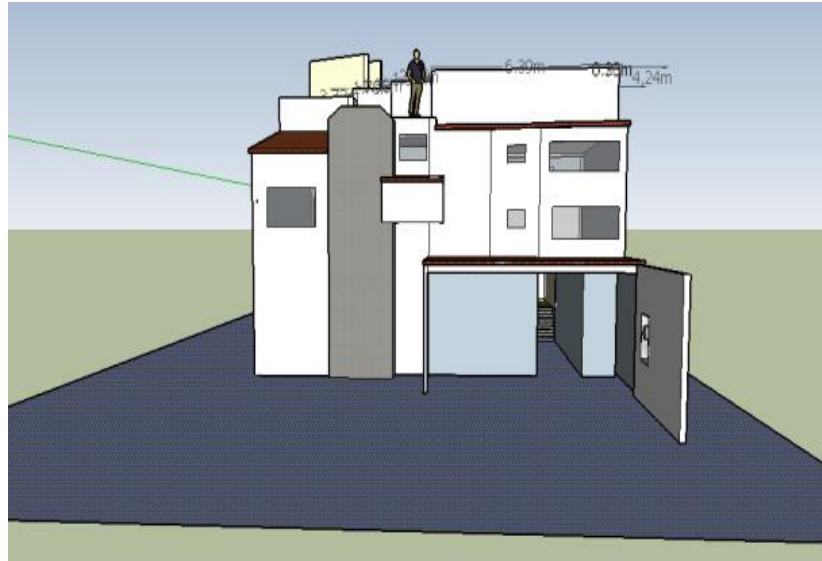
Plano 3D, vista frontal del sitio: aporte propio.
